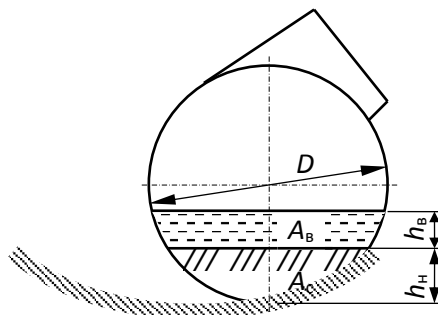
Схема к расчету площади поперечного сечения слоя воды над наносами
